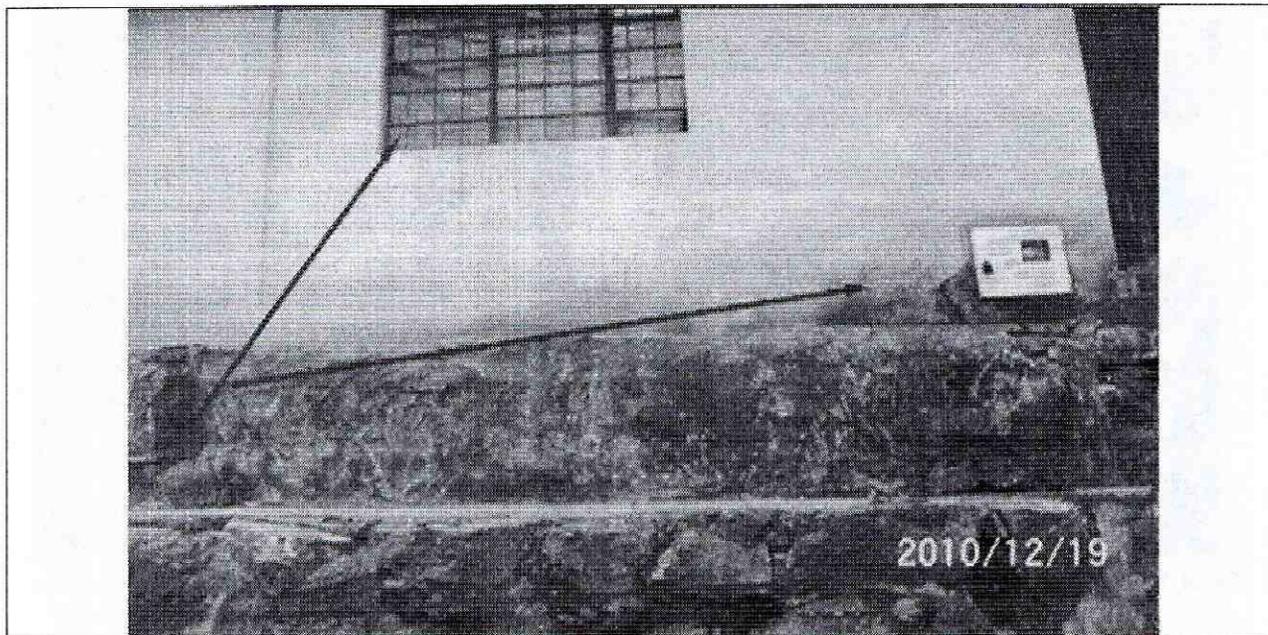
Grietas exteriores en vivienda construida al pie del talud
